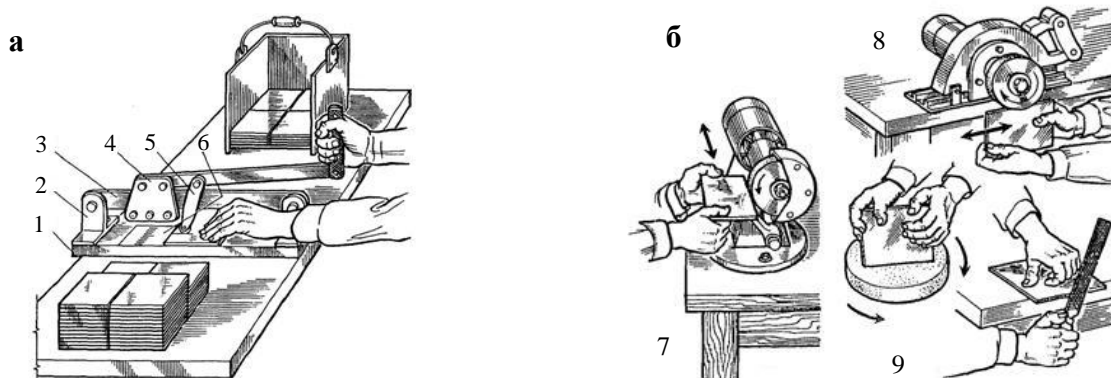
Оброблення личкувальної плитки: а – різання керамічної плитки за допомогою важільного плиткоріза; б - вирівнювання (підточування) крайок плиток; 1 – дерев'яна підставка плиткоріза; 2 – металеві стояки; 3 – напрямна планка-траверса; 4 – каретка; 5 – притискний важіль з роликівим ножом; 6 – мірна лінійка з наполегливою планкою; 7 – на стаціонарному точилі; 8 – на переносному інструменті із шліфувальним кругом; 9 – вручну за допомогою шліфувального круга або рашпіля
